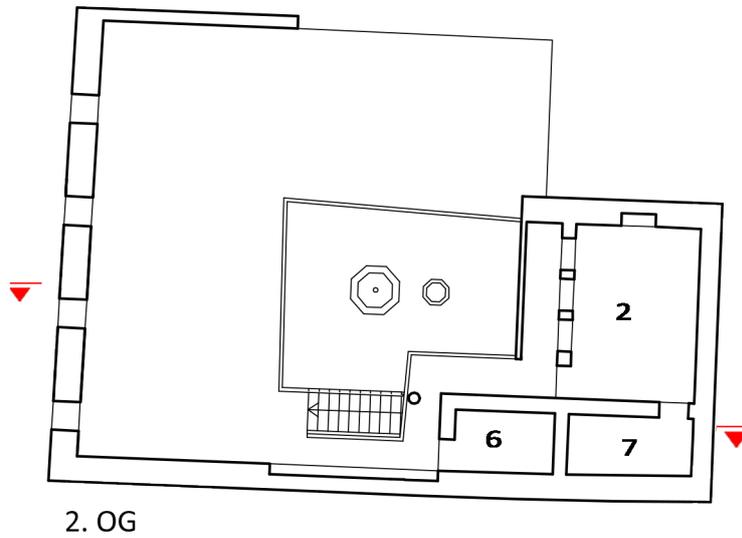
ein traditionelles Haus in Daraeiah in der Gegend Wadialajam-Grundrisse M:1/200
